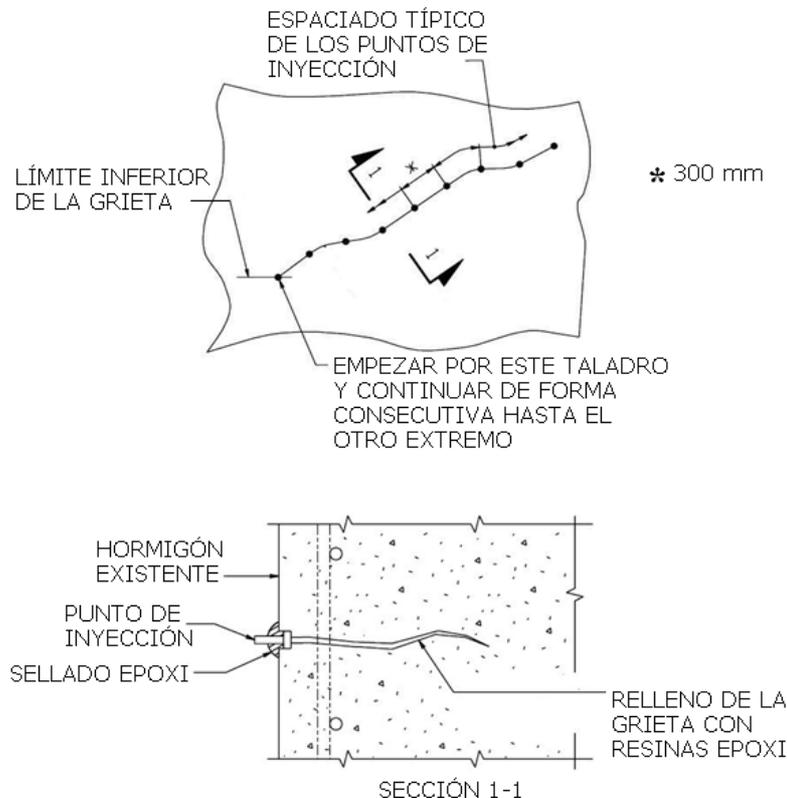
Reparación de una grieta estructural (FHWA).
